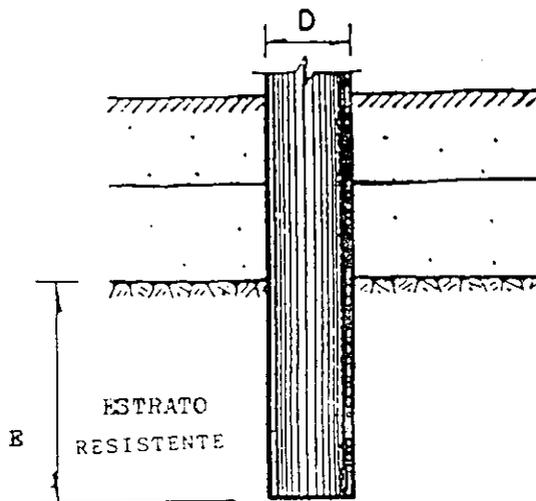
PILAS DE PUNTA CON ENPOTRAMIENTO.
